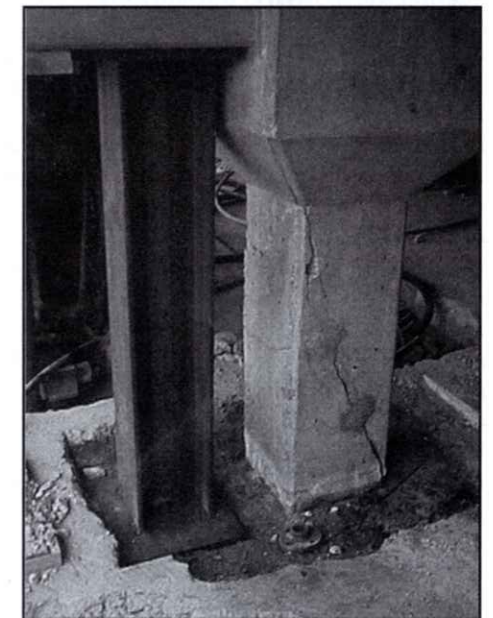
Apeo urgente por rotura del pilar. Perfil metálico en exterior.
